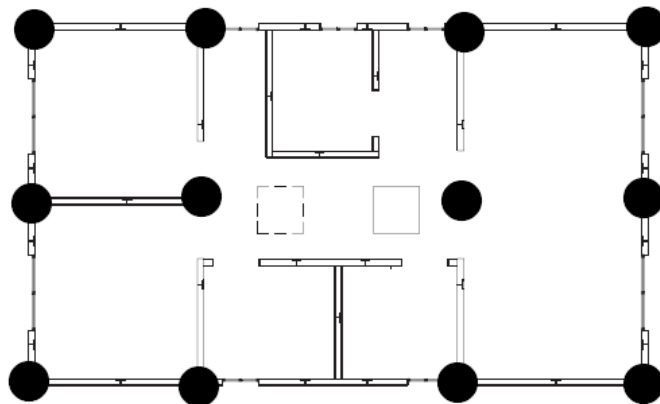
Distribución de aisladores en planta (Elaboración propia)
